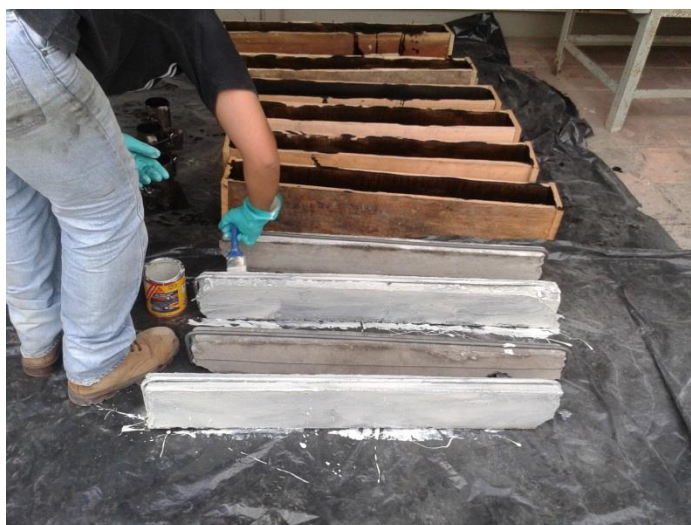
Aplicación adhesivo epoxico VC-1 y 2.
